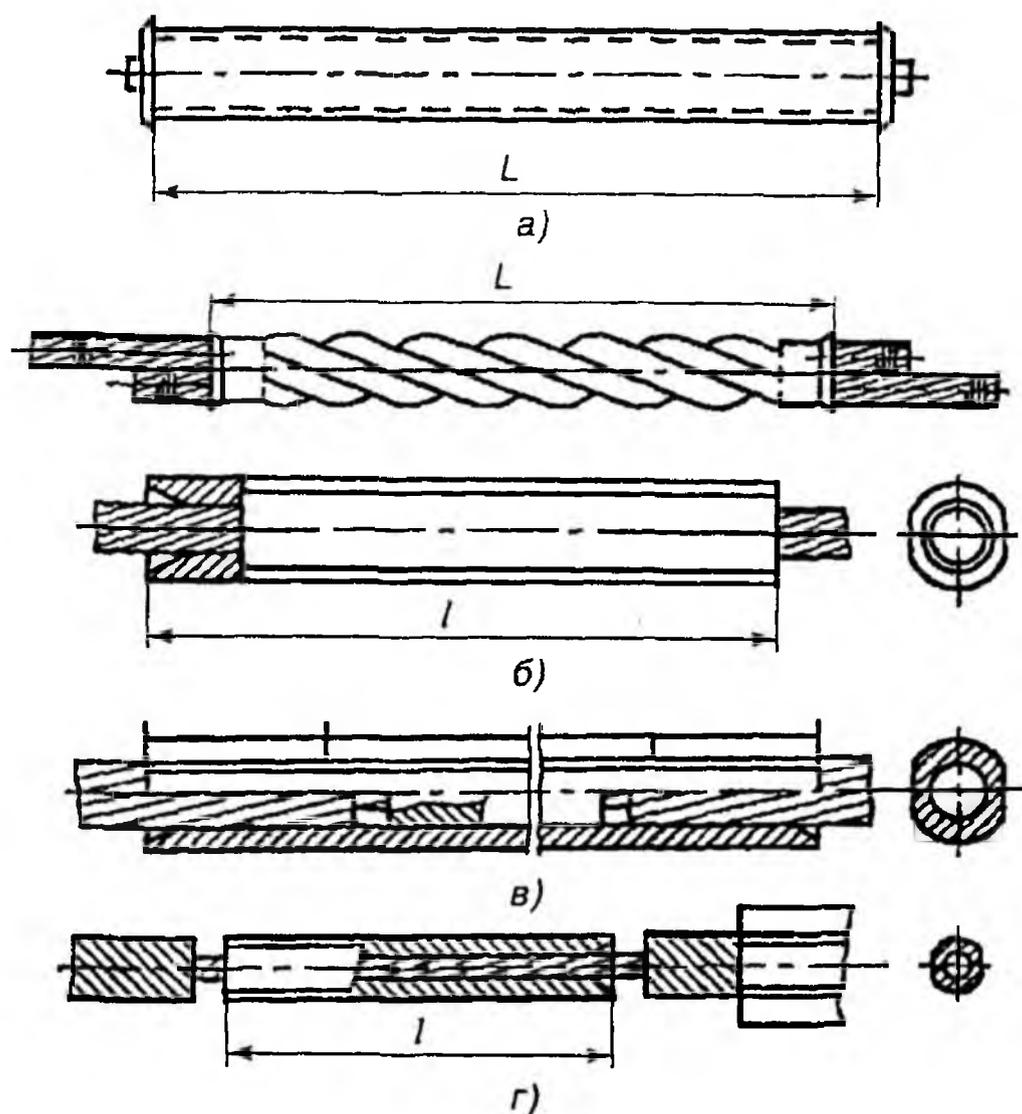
Овальный соединитель с введенными в него проводами:
